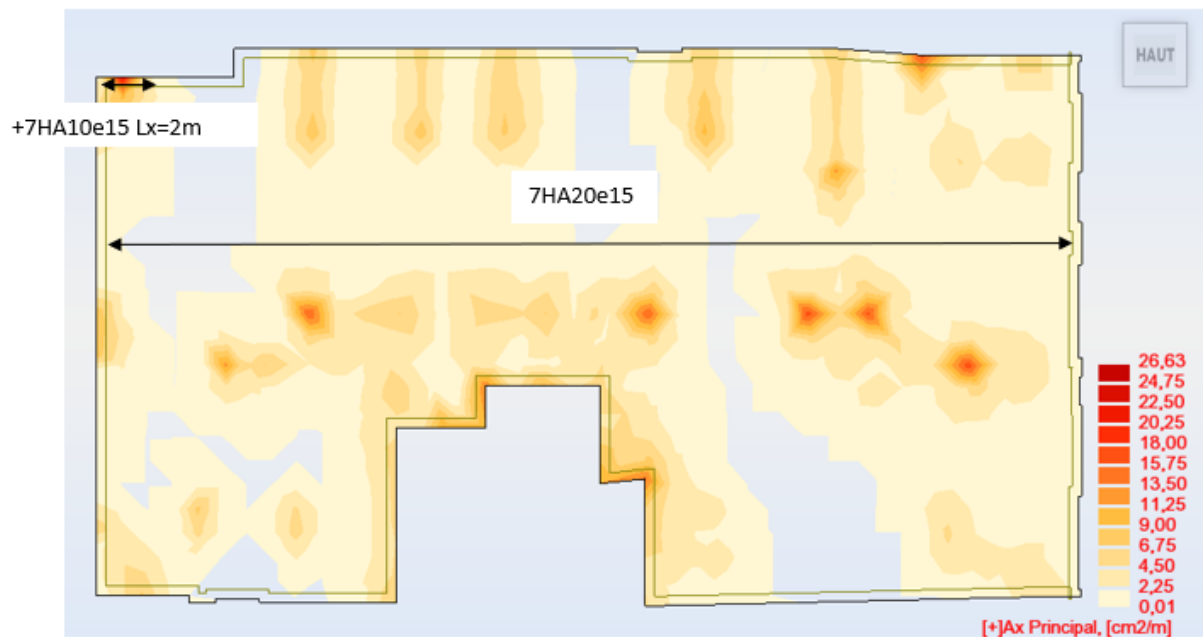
Schéma de ferrailage du plancher haut 1er étage (lit supérieur d'armatures principales $A_x(+)$)
